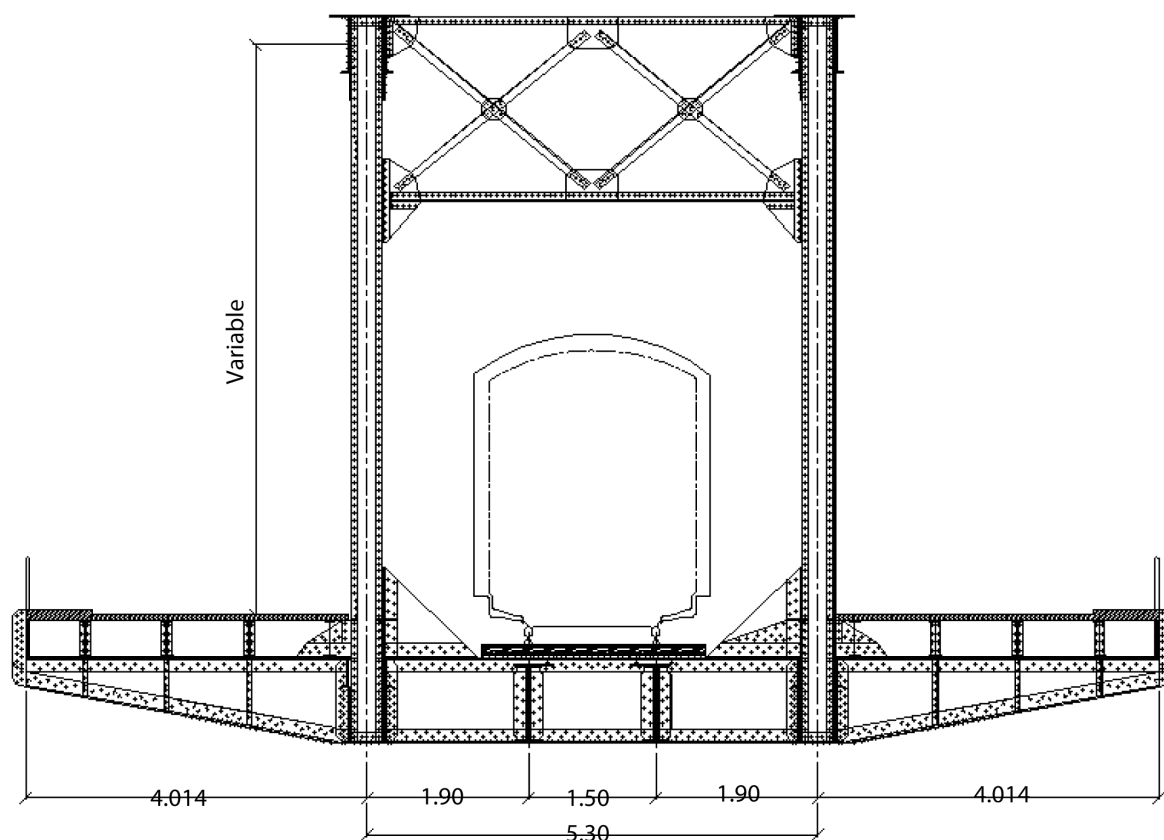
b : Coupe transversale du pont-rails d'Edfina.
